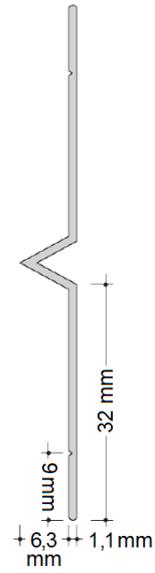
Exemple de bande PVC sur chevrons pour bande de protection
